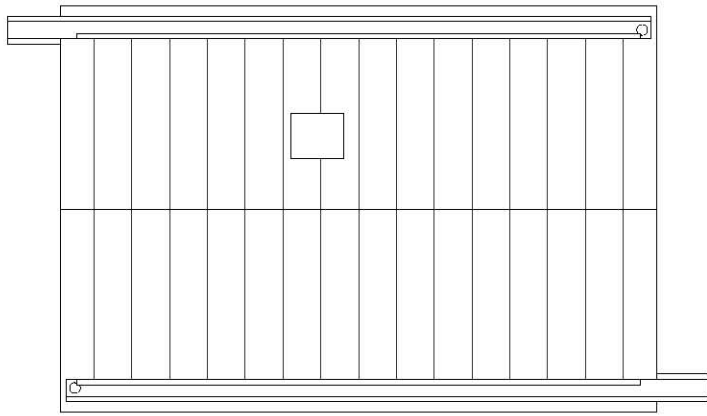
SISTEMA DE PAINÉIS, PLANTAS, ESCALA 1:100.
